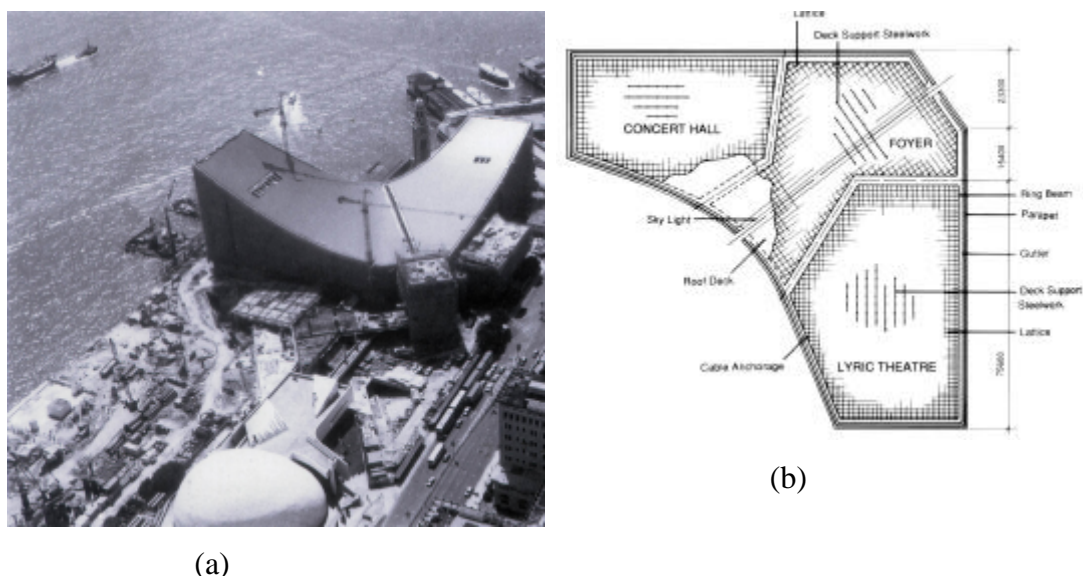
(a) Vista área e (b) planta da cobertura do centro cultural –
